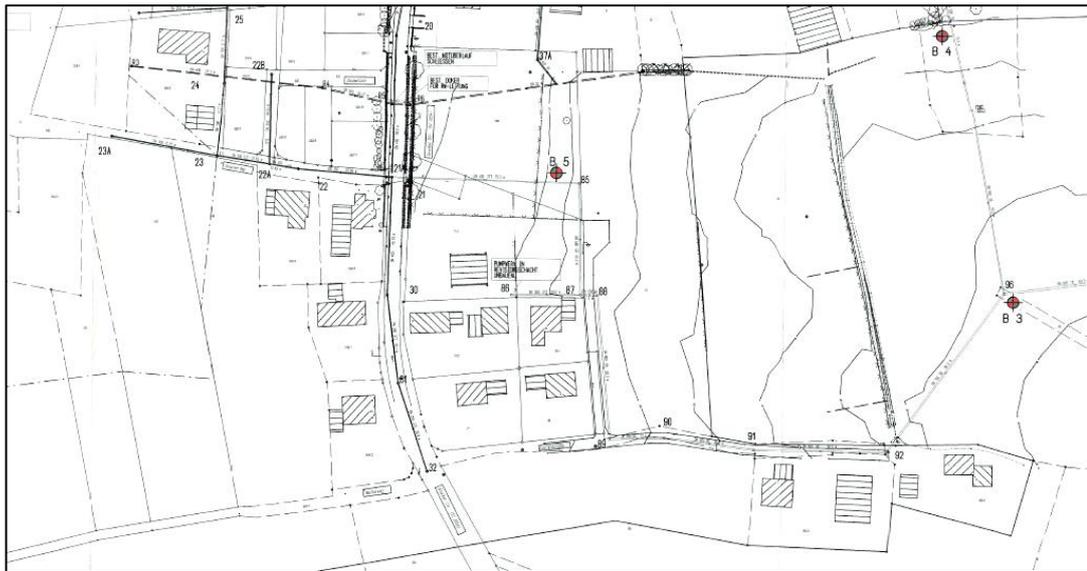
Lage der Bohrprofile B3, B4 und B5; Quelle: Baugrundgutachten Crystal Geotechnik in der Fassung vom 25.06.2020
